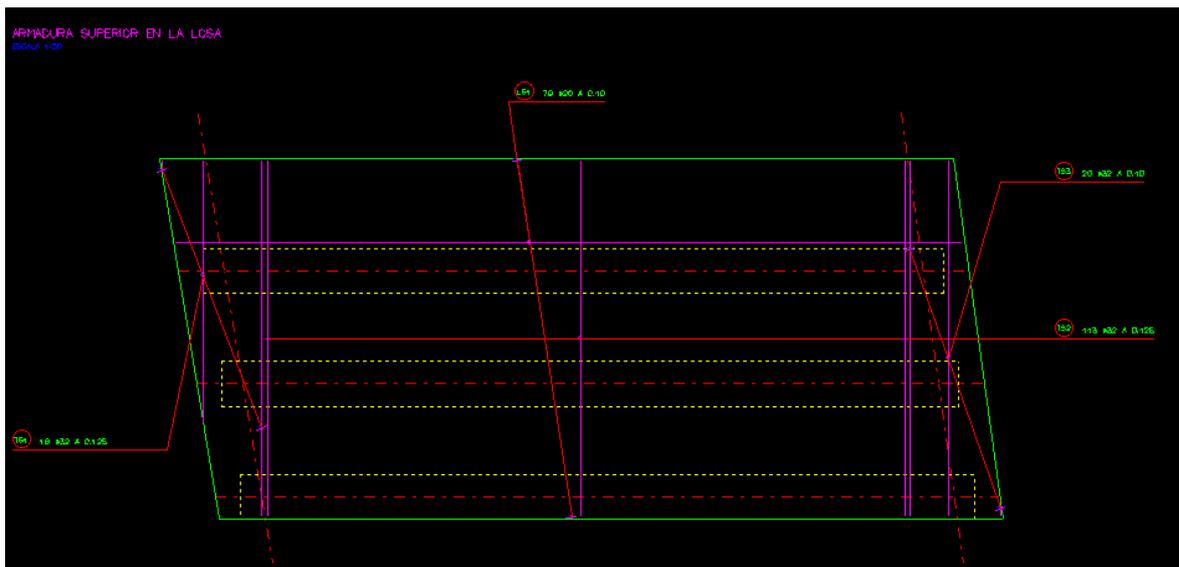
Figura *Losa. Planta. Armadura. Cara superior.
